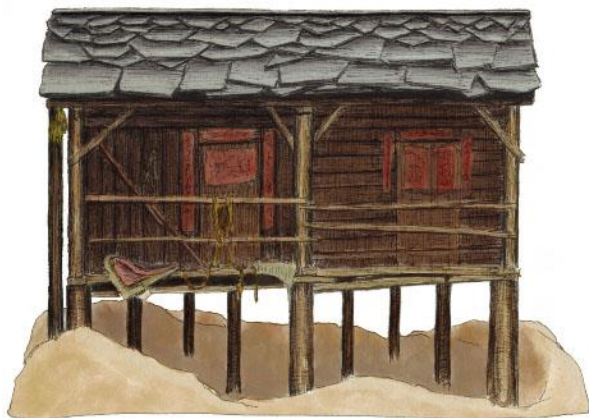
Фасад традиционного жилого дома в уезде Гуншань
